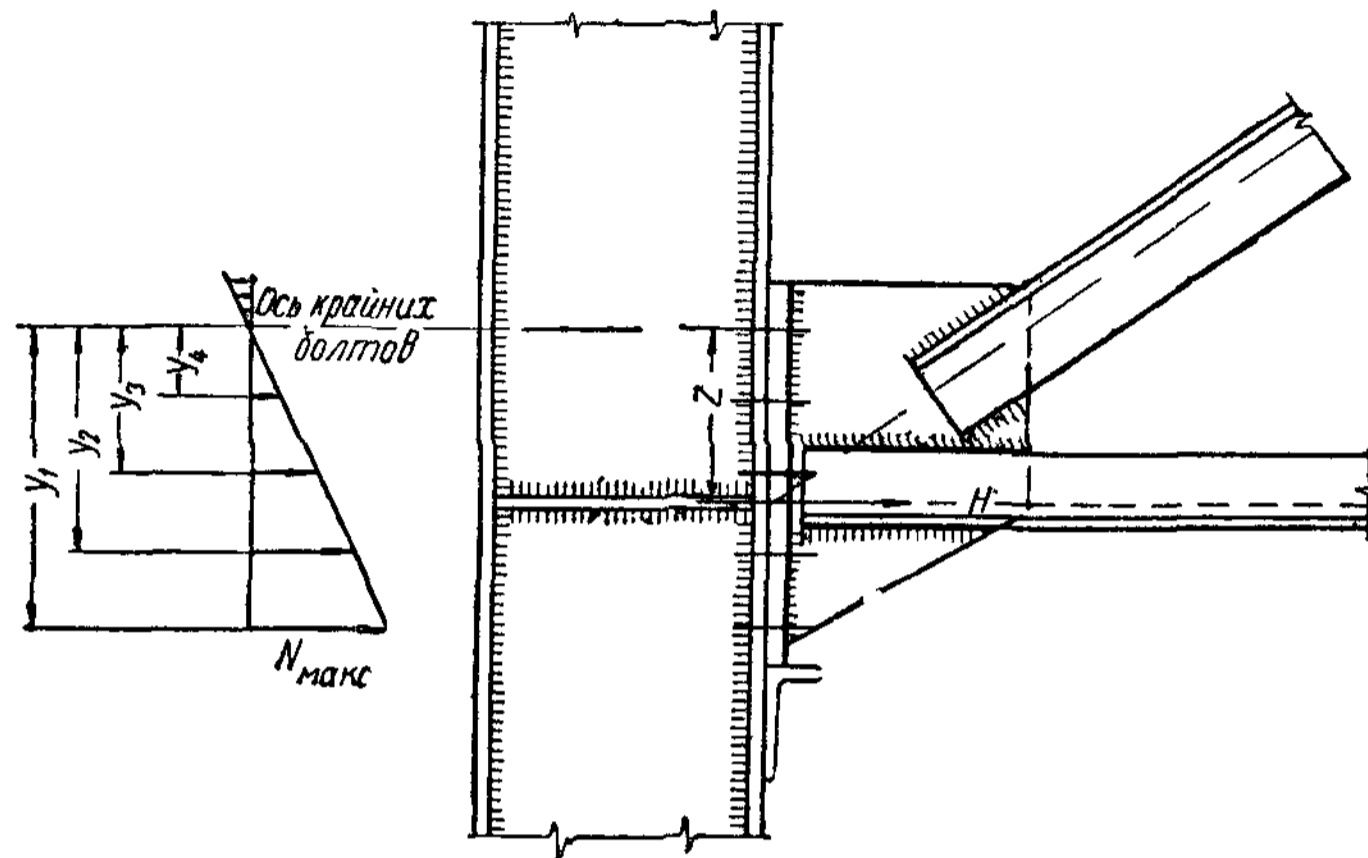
К расчету болтового соединения опорного узла ригеля с колонной
